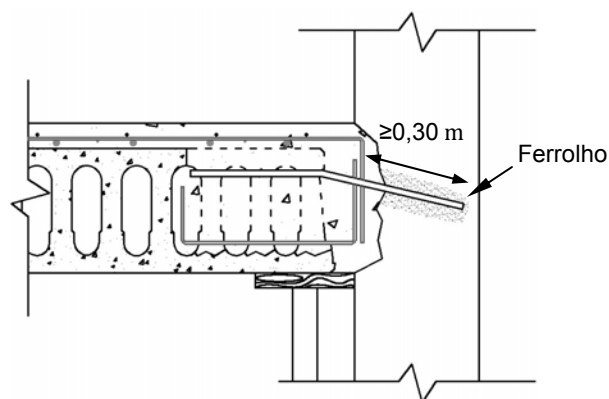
Ligação laje – parede através da execução de ferrolhos
